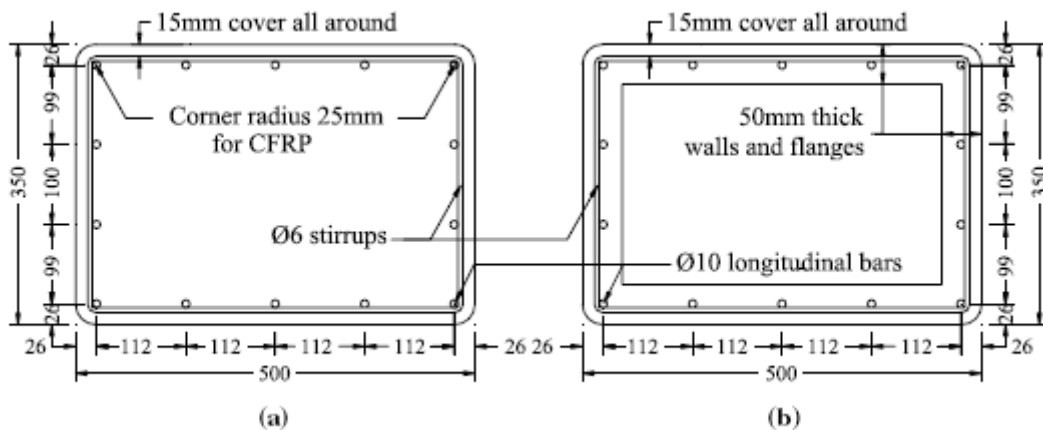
Disposition des armatures de a) Poutre à section pleine, b) poutre à section évidée
